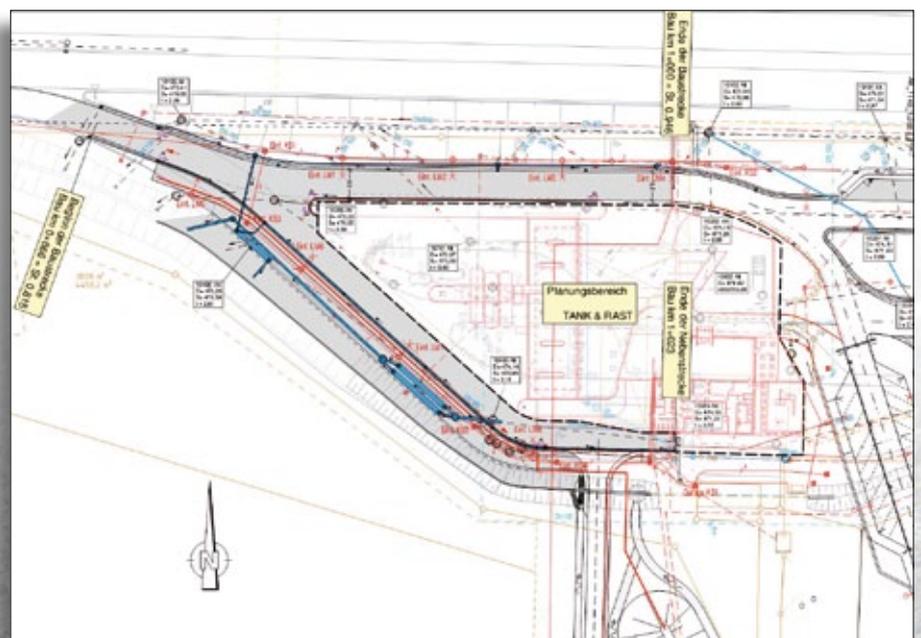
zweiter Bauabschnitt mit Zufahrtsbereich zur Tankstelle einschließlich Durchfahrt und Nebenflächen.
